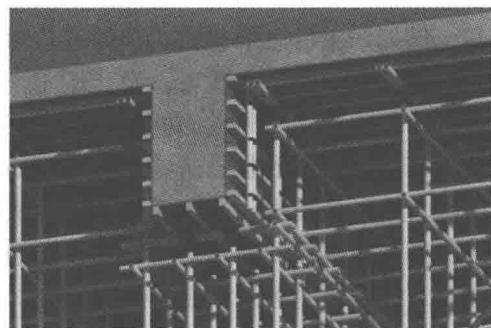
现浇混凝土梁板 BIM 技术模拟
